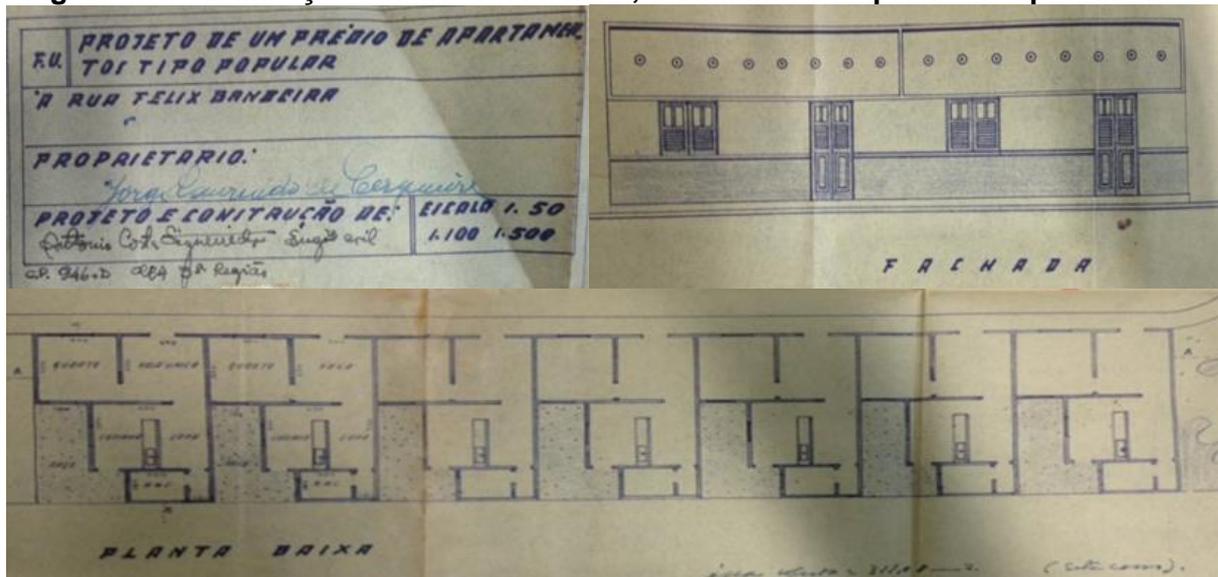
Situação e planta baixa tipo da primeira edificação multifamiliar vertical no Farol
